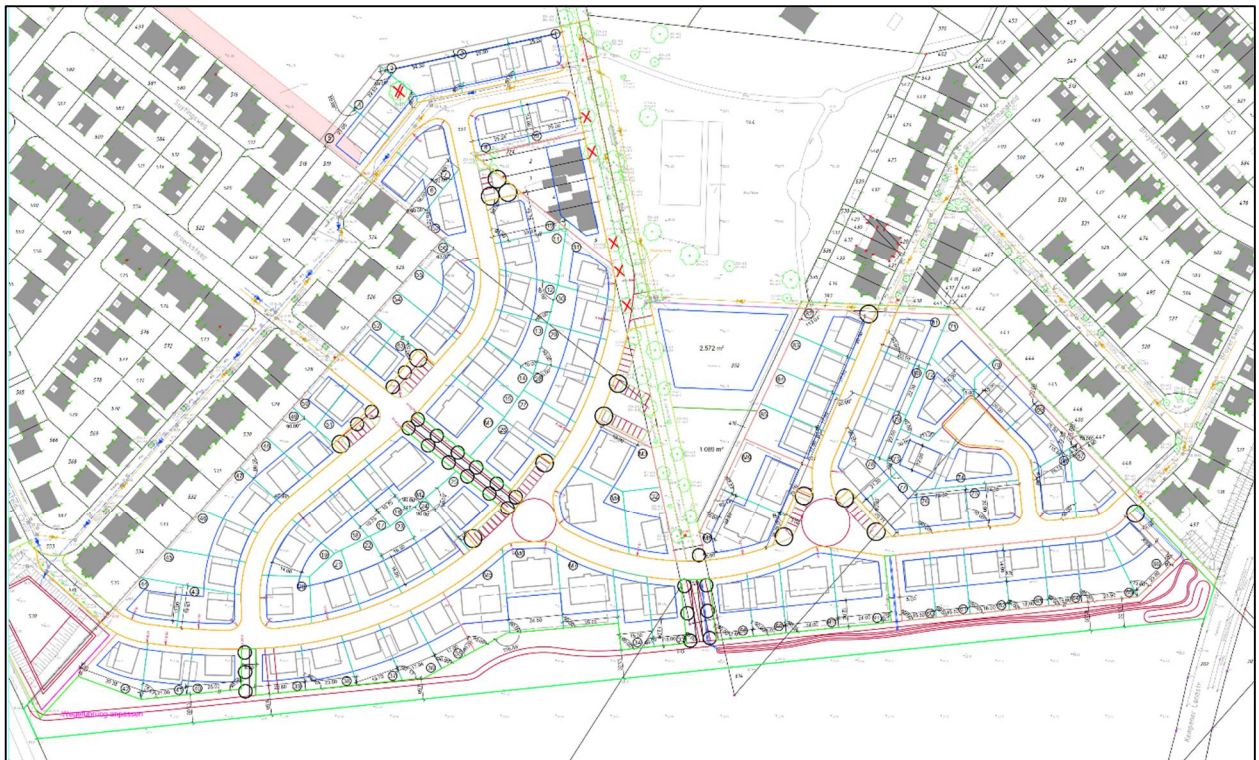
Lageplan mit geplanten Baugrenzen (unter Vorbehalt) des geplanten Wohngebietes Aldekerk-Süd (2. Bauabschnitt) in Kerken-Aldekerk, Stand: 27.07.2023 (Quelle: Ingenieur- und Planungsbüro LANGE GmbH & Co. KG).
